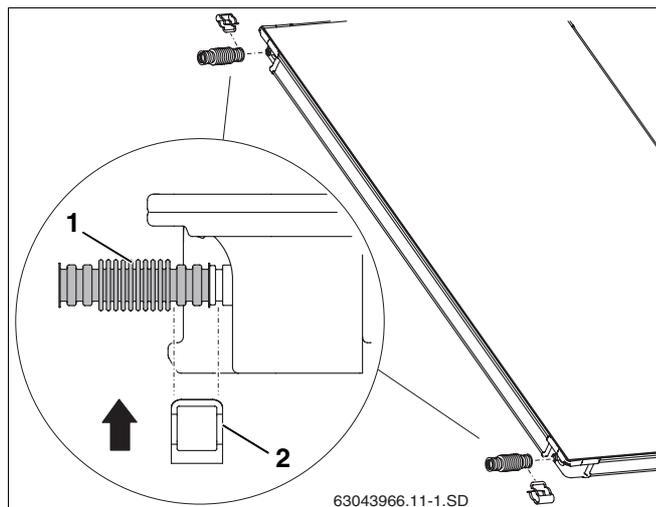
Montaggio del raccordo per tubo ondulato sul primo collettore
